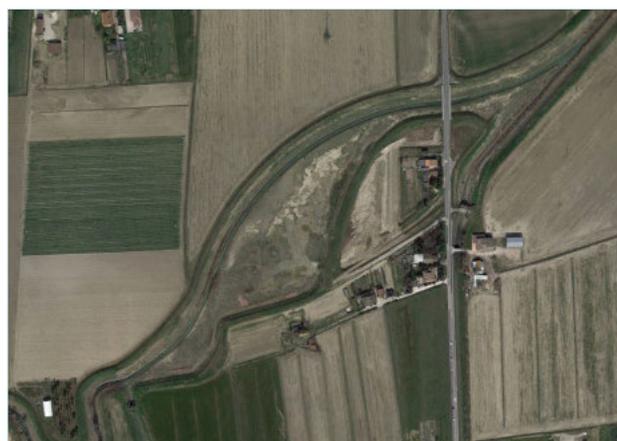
Bevano S.Zaccaria – fase di cantiere e fine lavori
